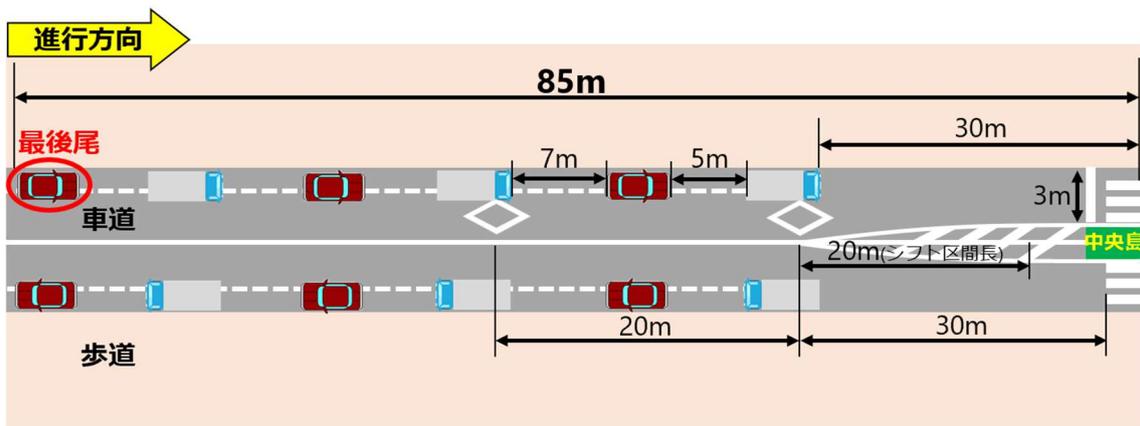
二段階型横断歩道(パターン3)の車両配置図
